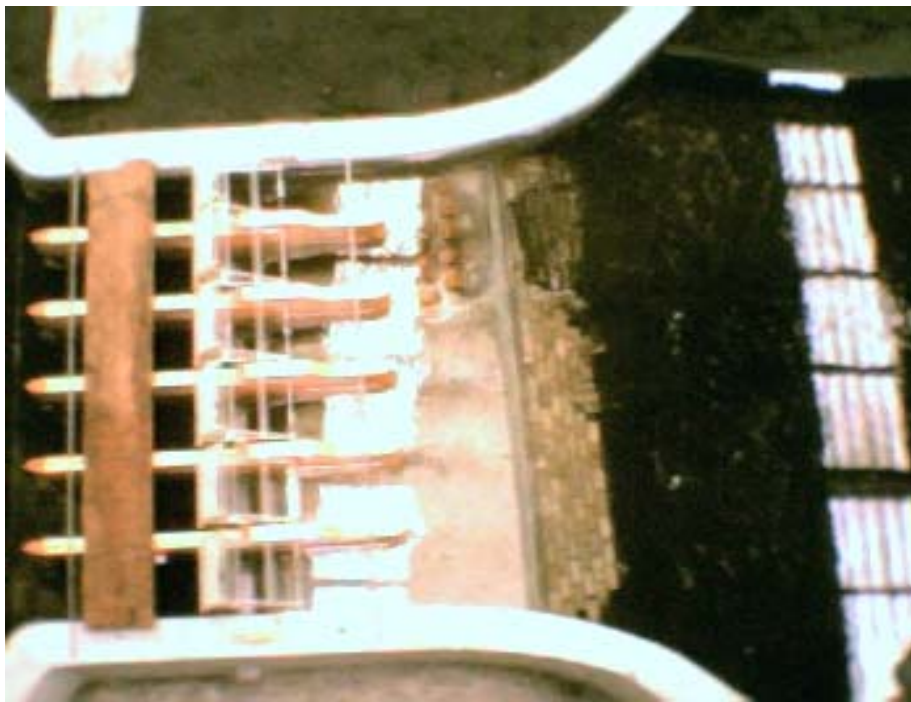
Detalle de socavación generada por la estructura.
